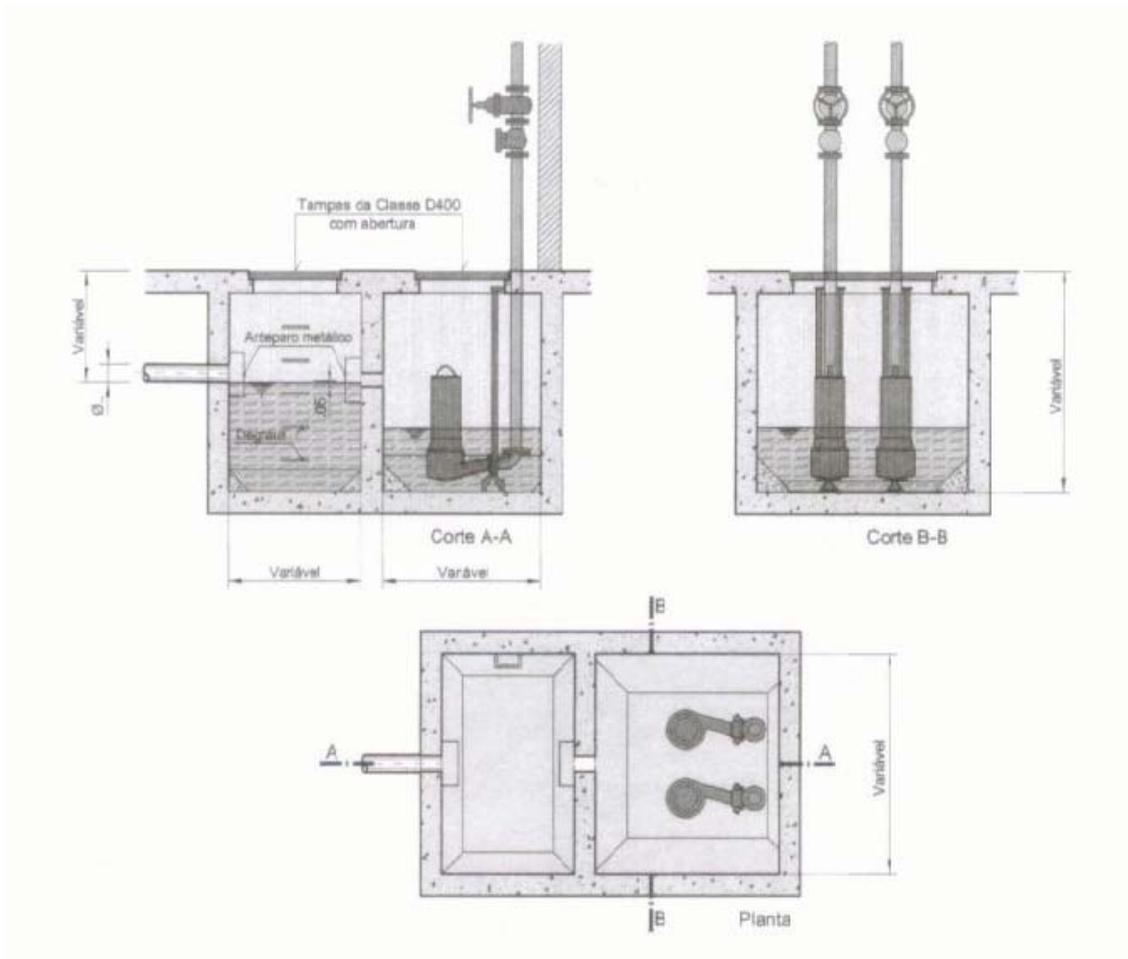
Planta e cortes da câmara retentora e poço de bombagem
